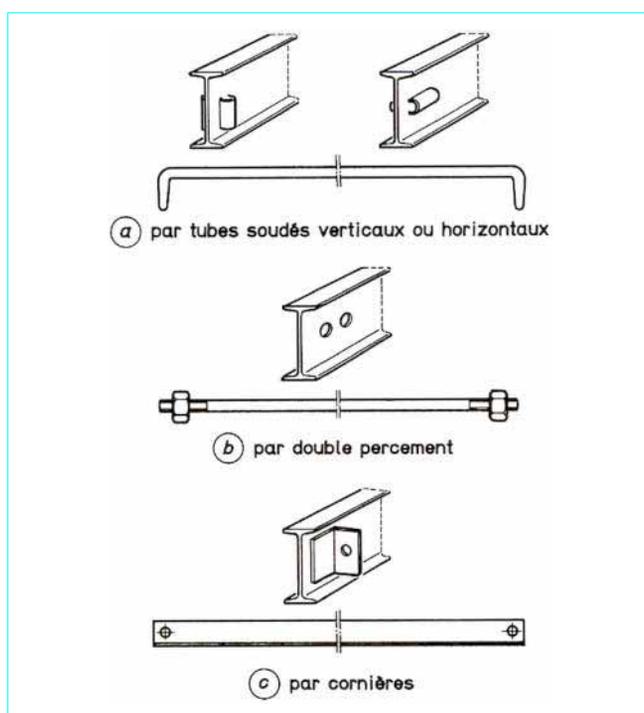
Dispositifs d'entretoisement de cintres lourds
